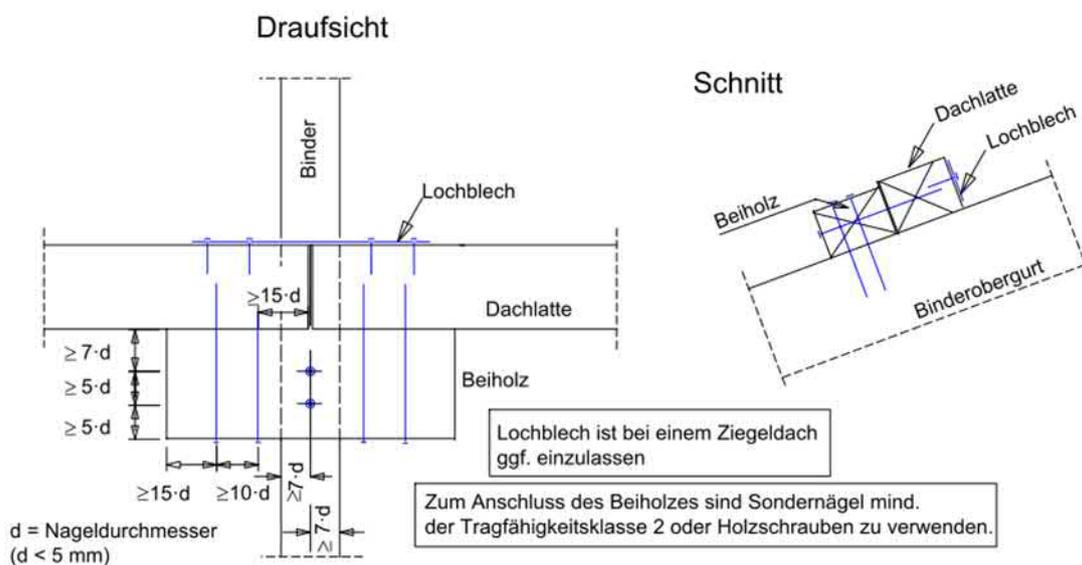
Stoß der Dachlatten mit einem Beiholz und einem Lochblech mit Angabe der Mindestabstände der Latten (dargestellt sind die Mindestnagelanzahlen)
